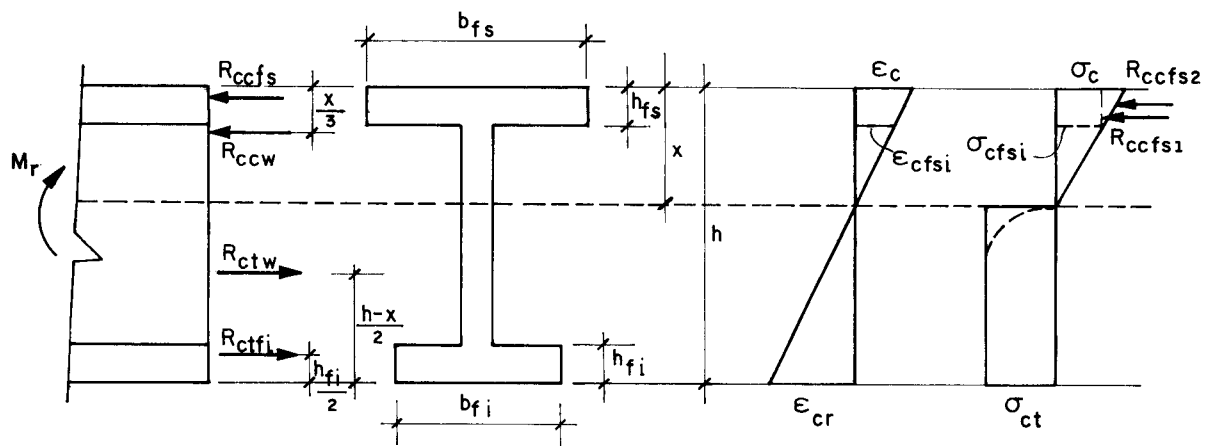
MOMENTO DE FISSURAÇÃO — LN NA ALMA
